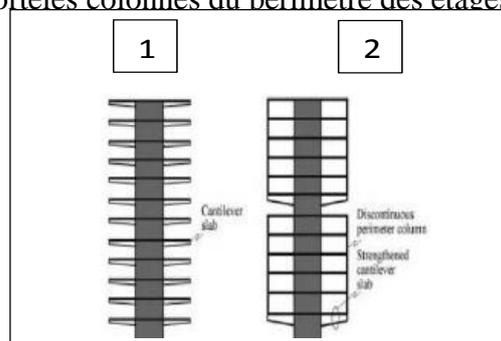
Dalles dans le système à noyau central (1) dalle pote a faux ; dalle en console renforcées
